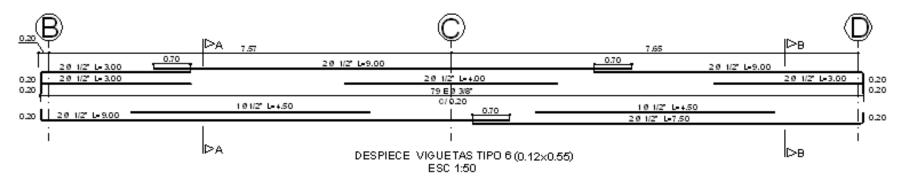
Detalle de la Sección Transversal de vigueta especial.
